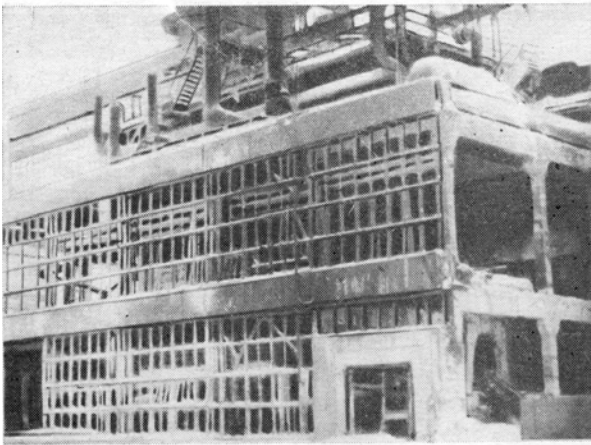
Залізобетонний каркас промислової будівлі після пожежі [3]
